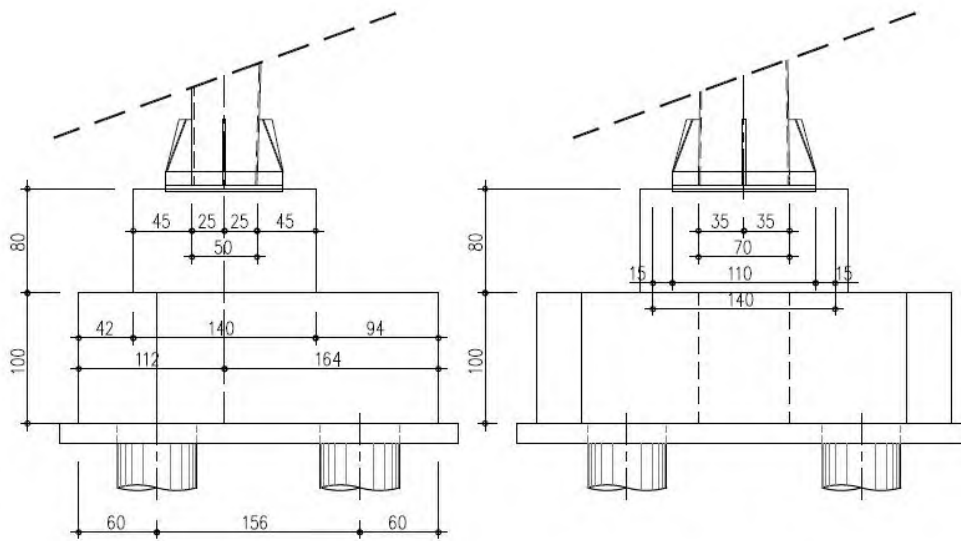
Sezioni del plinto di fondazione - terreno pianeggiante
